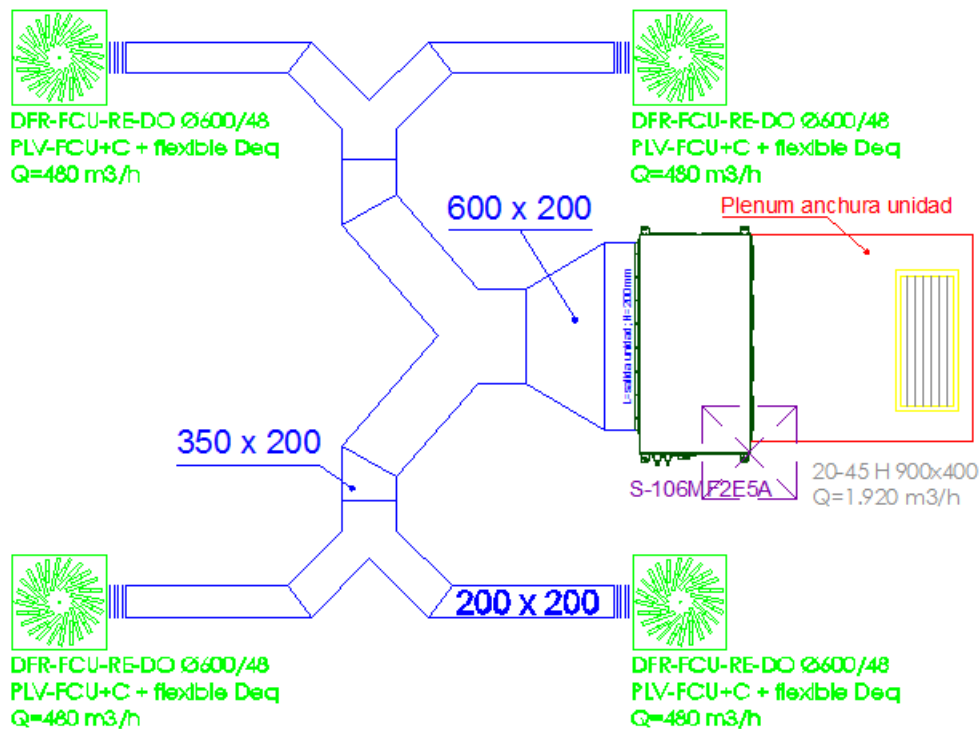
Imagen difusión de la unidad en comedor Planta Baja
